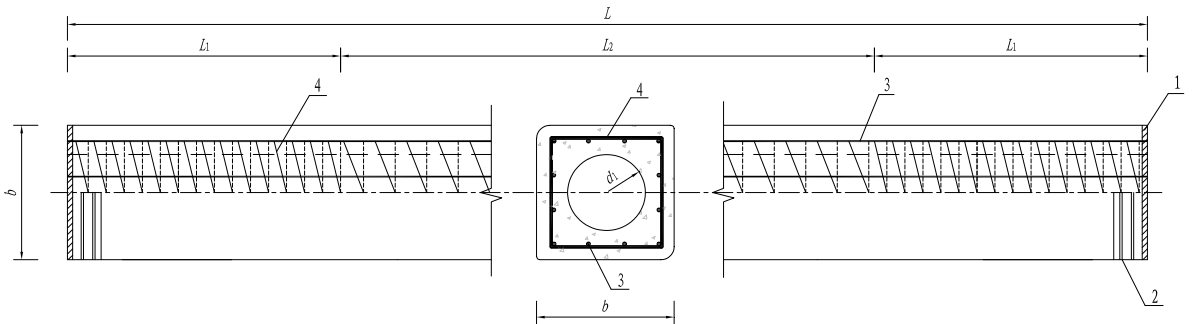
方桩（预应力混凝土空心方桩、预应力高强混凝土空心方桩、预应力超高强混凝土空心方桩、薄壁混凝土空心方桩）结构形式示意图
